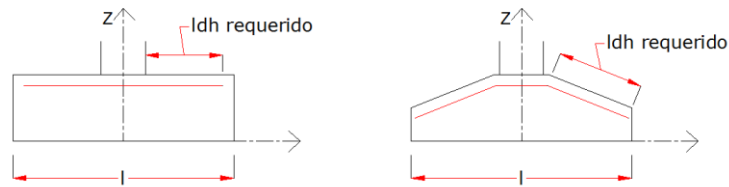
Longitud de anclaje de las barras de zapata. Fuente: elaboración propia.
